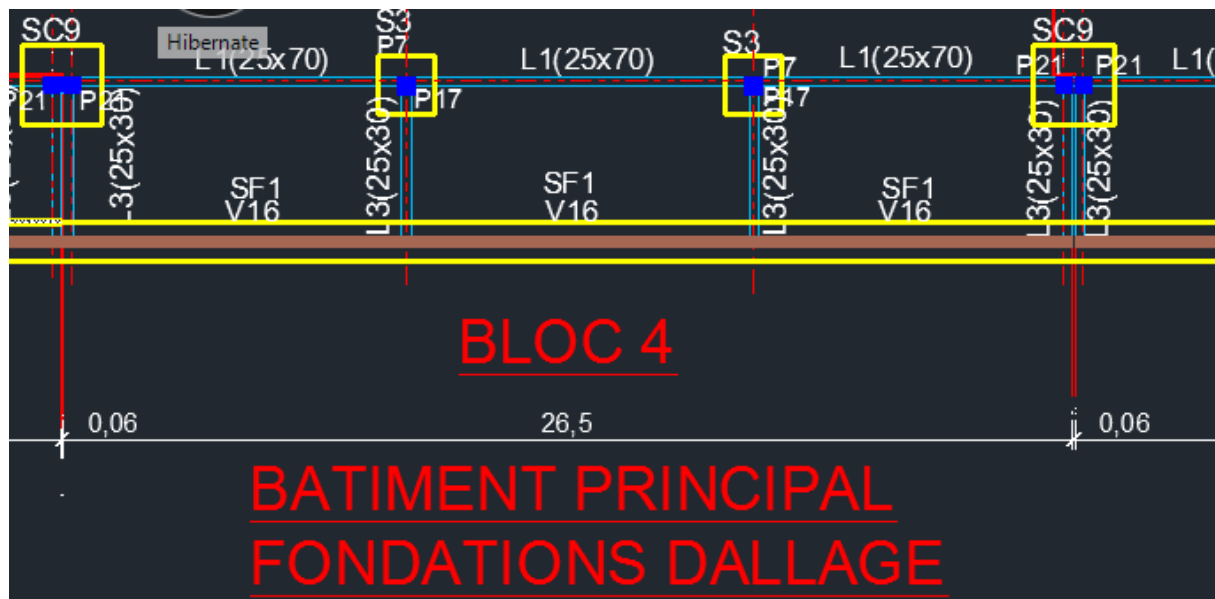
joints de dilatation de 6cm au niveau des fondations
